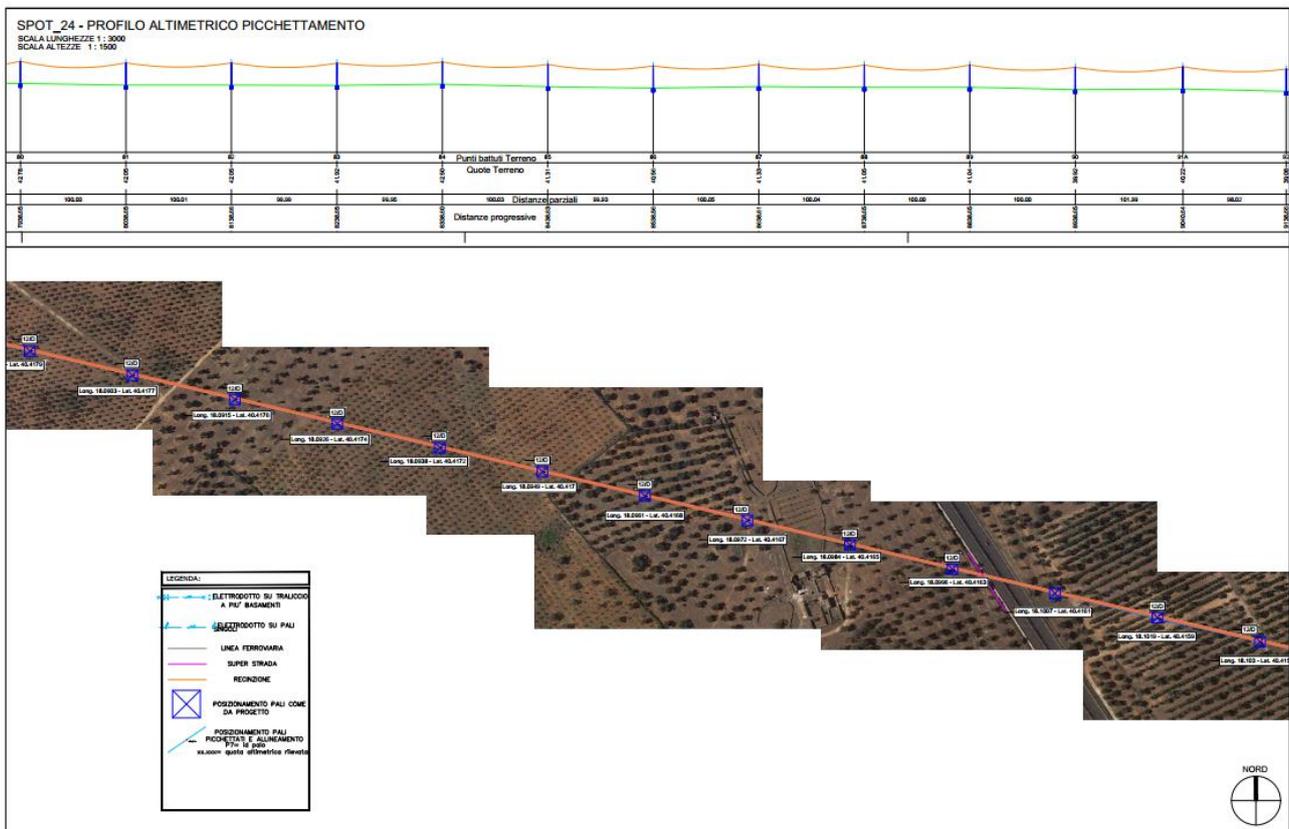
Profilo planoaltimetrico attraversamento ferrovia
